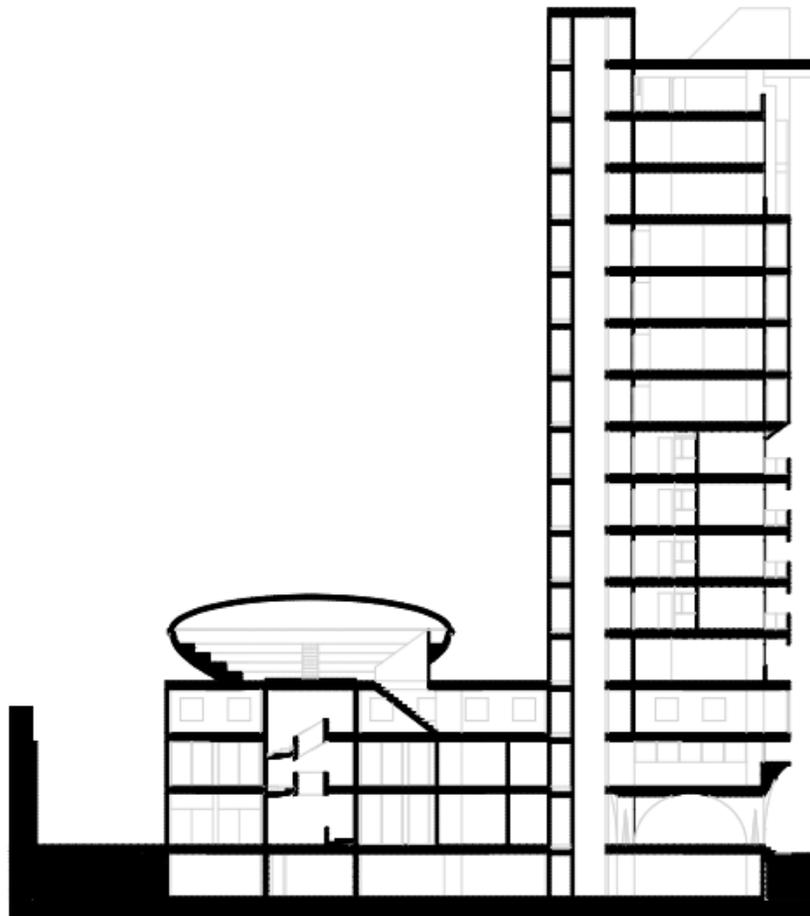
Sección longitudinal planificada. Fuente: Tesistas.
